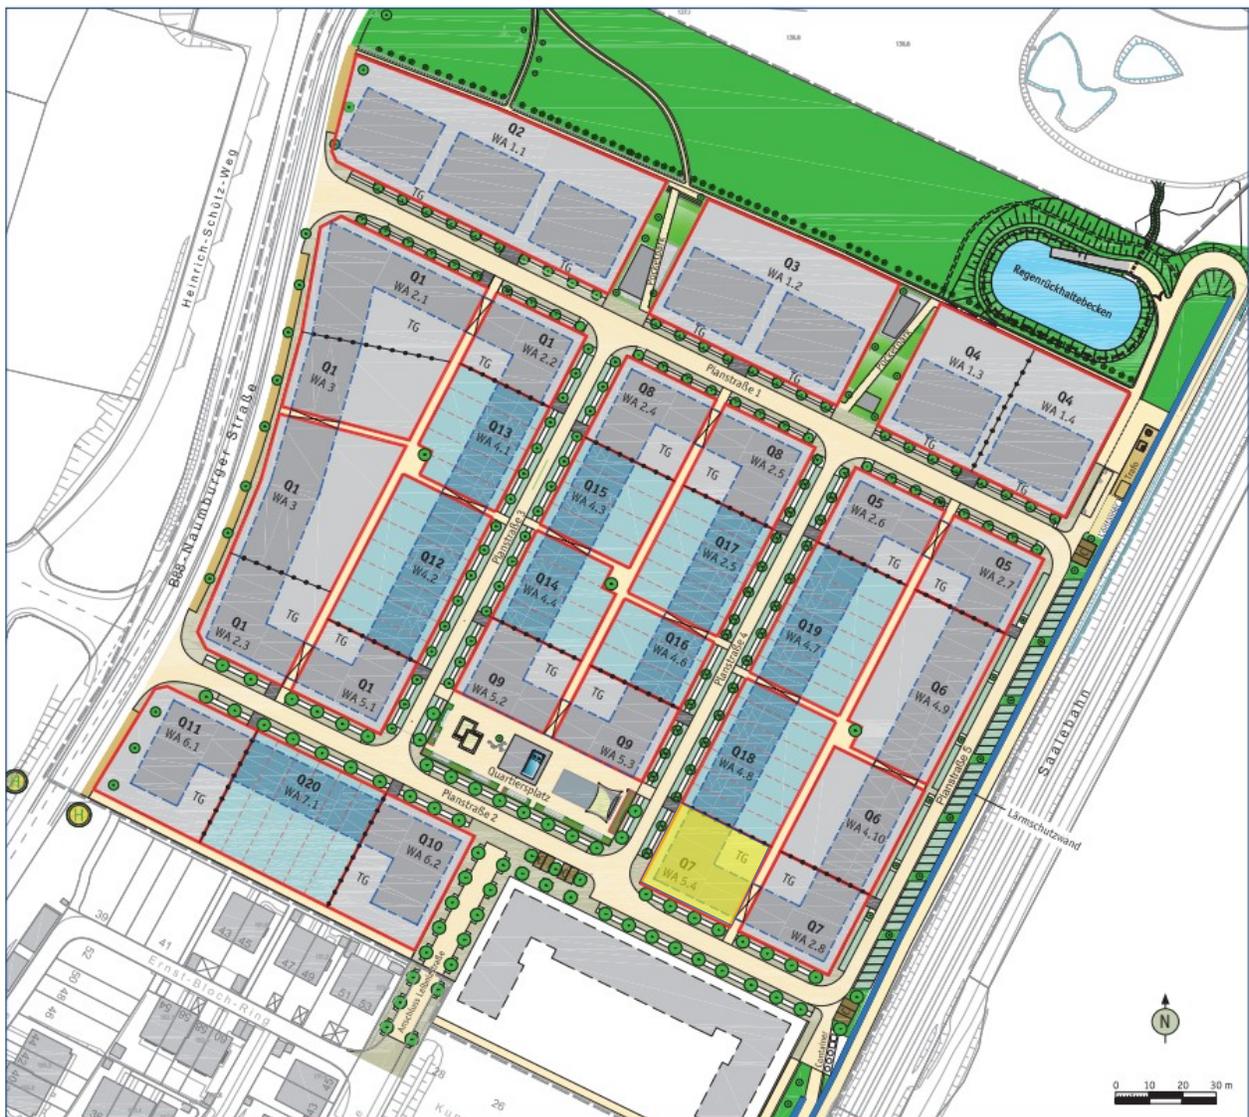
Parzellierungsplan „Am Oelste“ / Baufeld A gelb markiert (Quelle: Stadt Jena)
